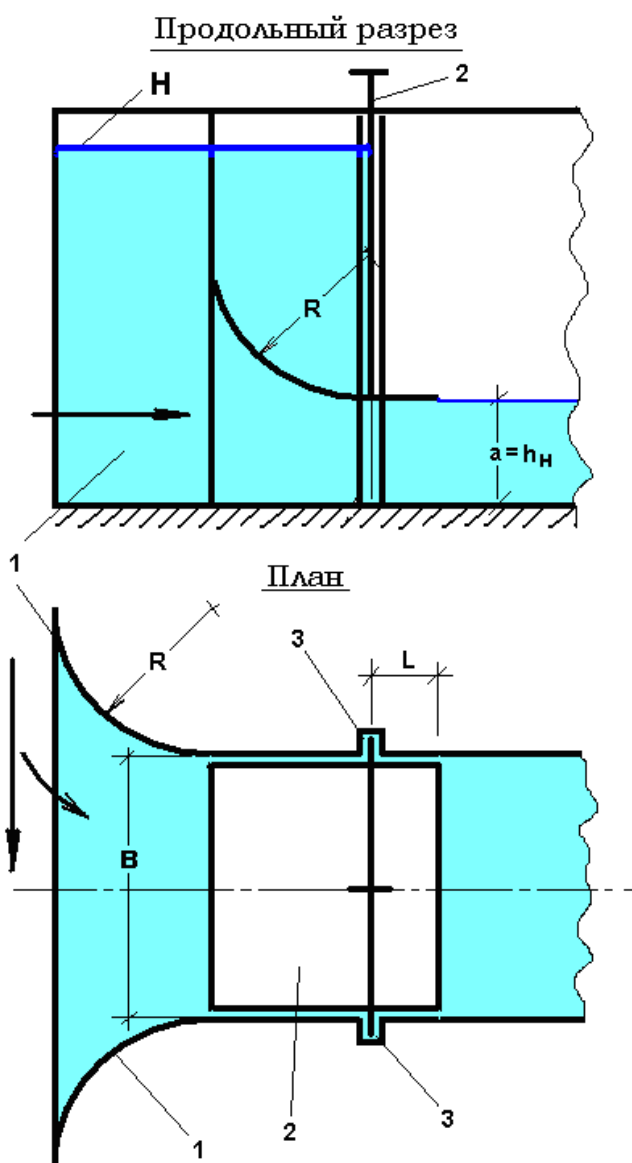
Схематическая конструкция выбранного типоразмера шлюза-водомера
